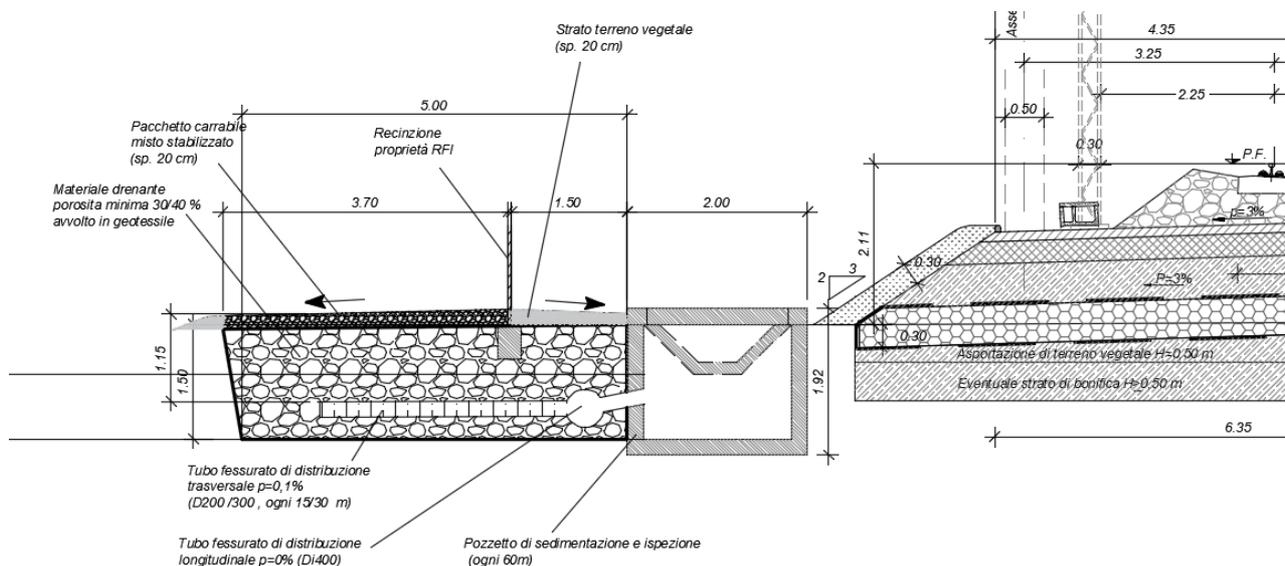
Sezione trincea drenante in corrispondenza del pozzetto di immissione
